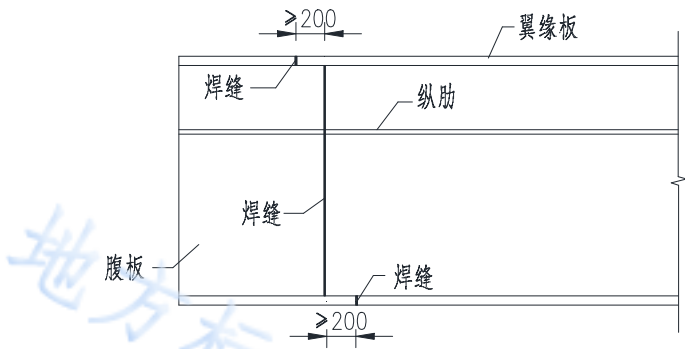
焊缝错开的最小距离（尺寸单位：mm）
